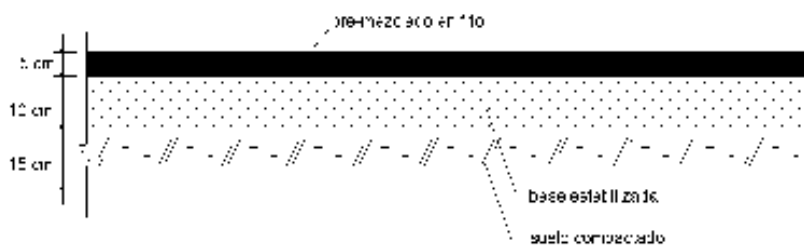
PAVIMENTO EN CONCRETO ASFÁLTICO – MEZCLA EN FRÍO.
